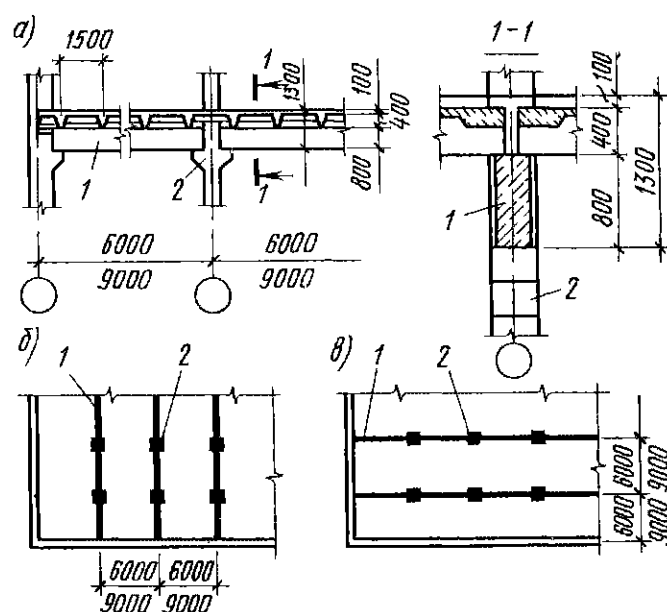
Пример конструктивной схемы ребристого перекрытия с балочными плитами а — поперечный разрез б — ригели поперек здания, в — ригели вдоль здания, 1 — ригели, 2 — колонны
